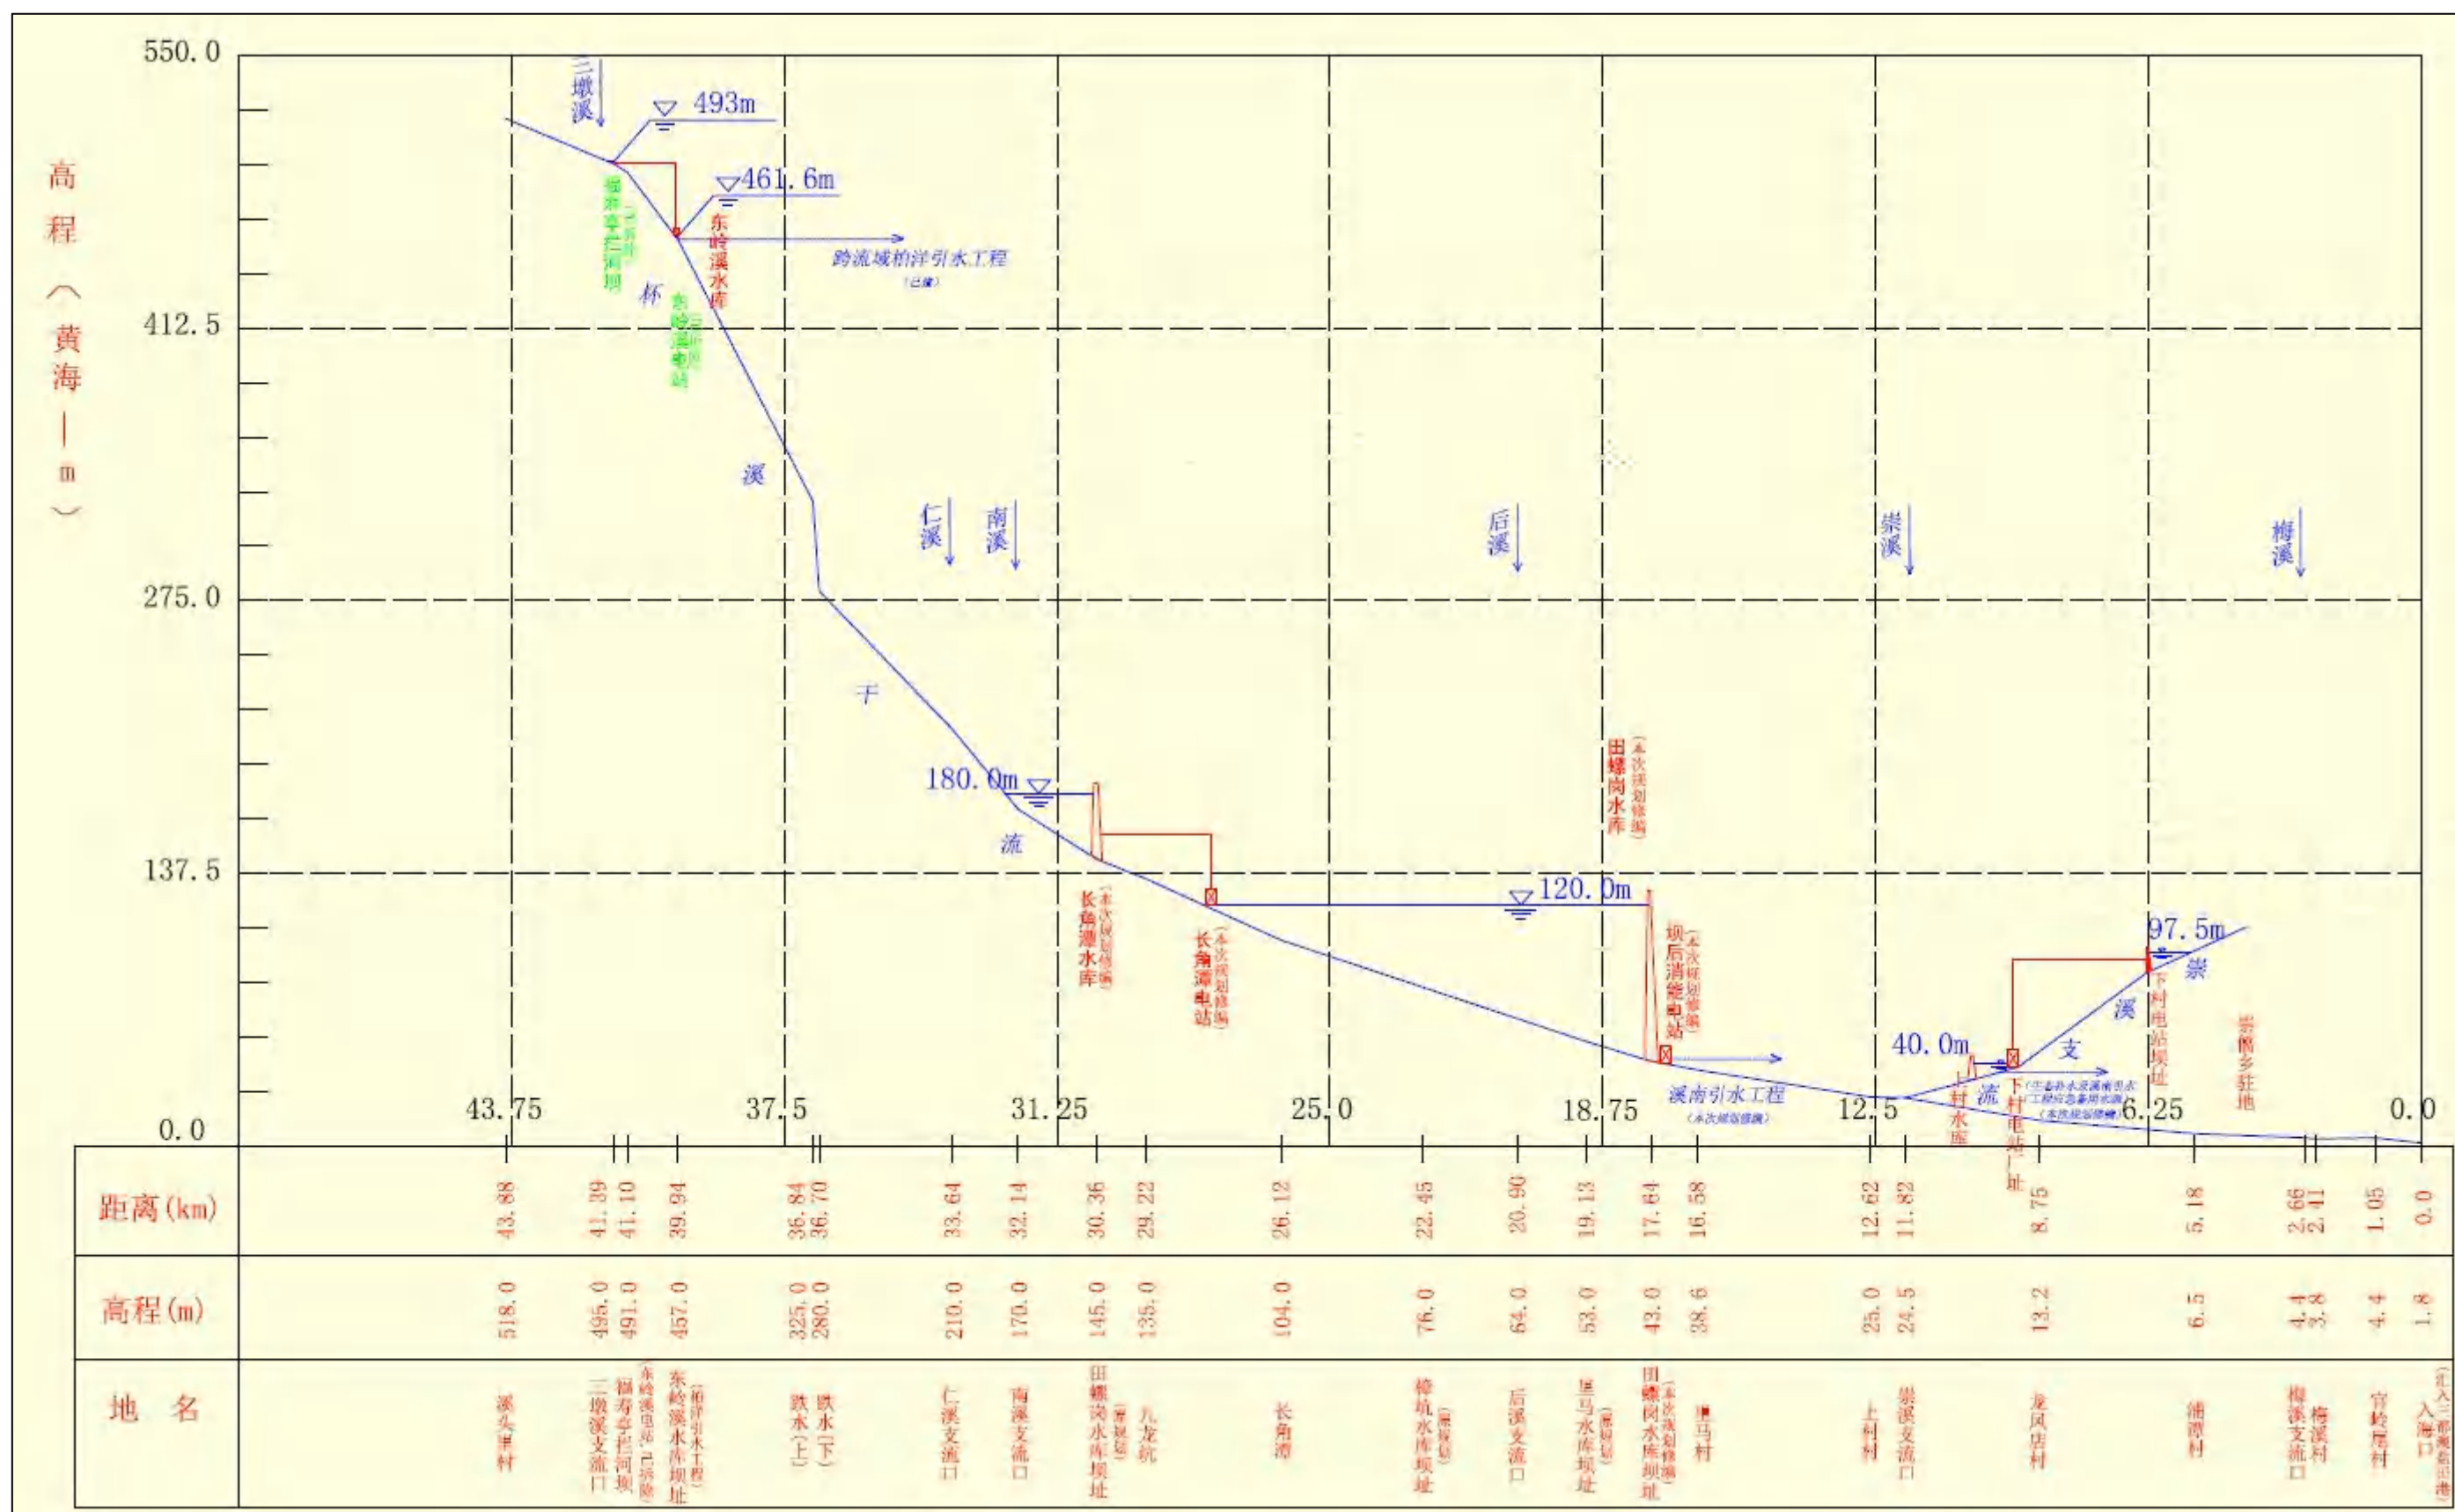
杯溪流域规划修编梯级开发纵剖面图
